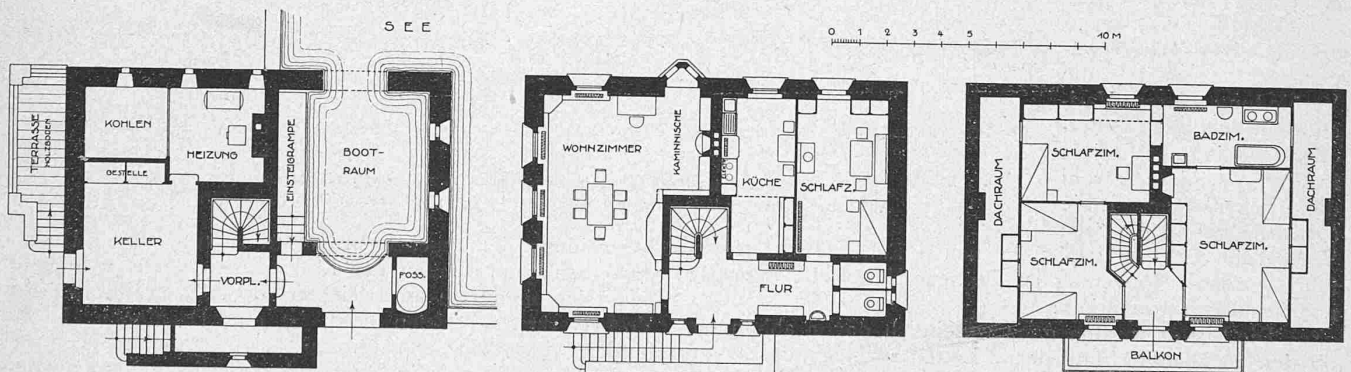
bis 7. Ferienhaus Bartuns. — Architekten Rittmeyer & Furrer, Winterthur. — Grundrisse, Masstab 1:250.
